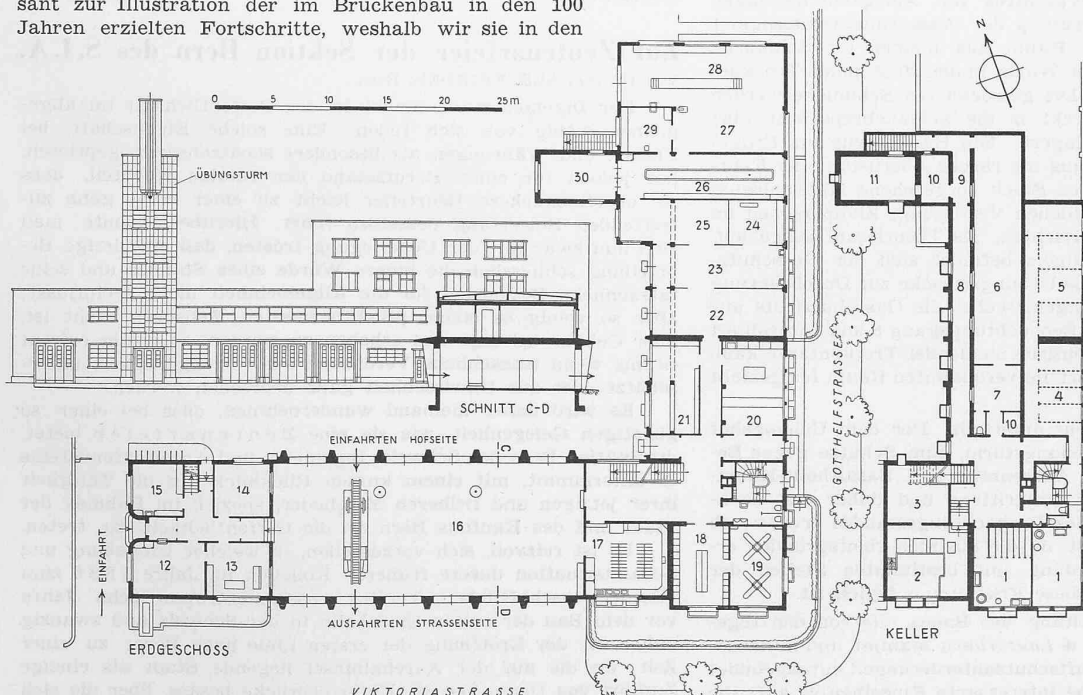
bis 3. Grundrisse vom Erd- und Untergeschoss, Hoffassade und Schnitt durch die Fahrzeughalle. — 1:600.
